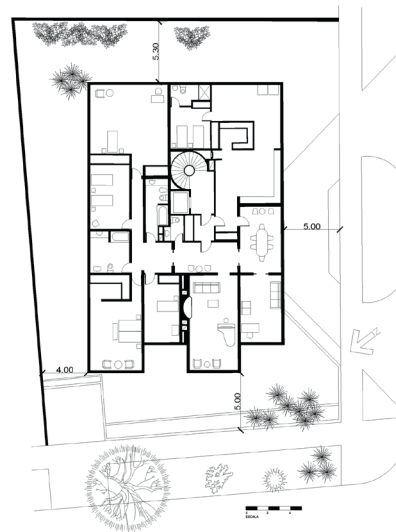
La posible versión ortogonal de la planta. Fuente: elaboración propia.
